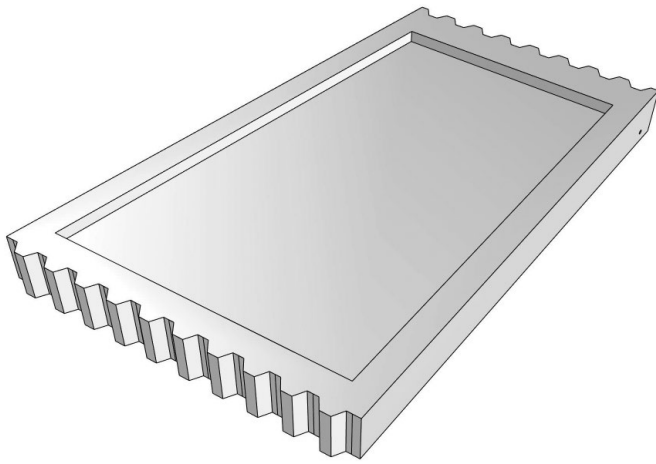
Formschlüssige Fugenausbildung des viereckigen Grundmoduls
